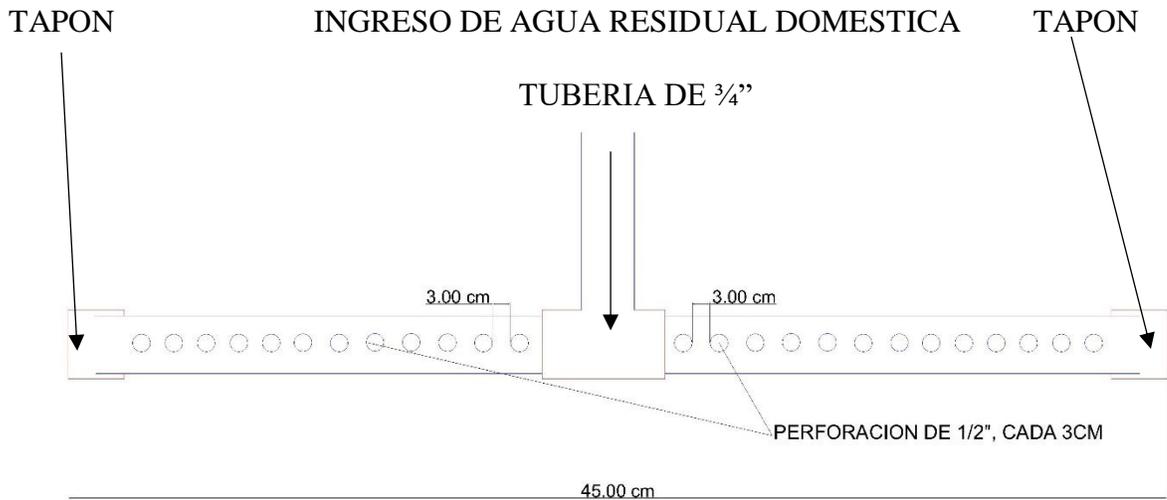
Tubería de distribución la Planta Piloto con perforación de 1/2"
